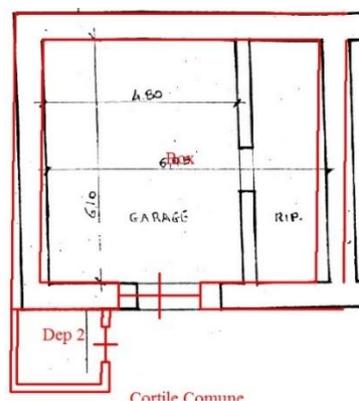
sovrapposizione dello stato reale dei luoghi al piano seminterrato e dell'allegato grafico al Permesso a costruire.
